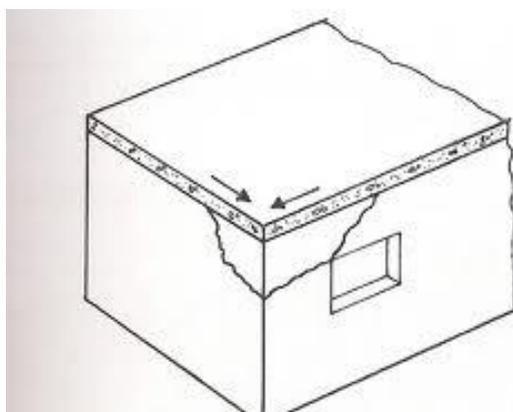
Trincas de cisalhamento provocadas por expansão térmica da laje de cobertura
